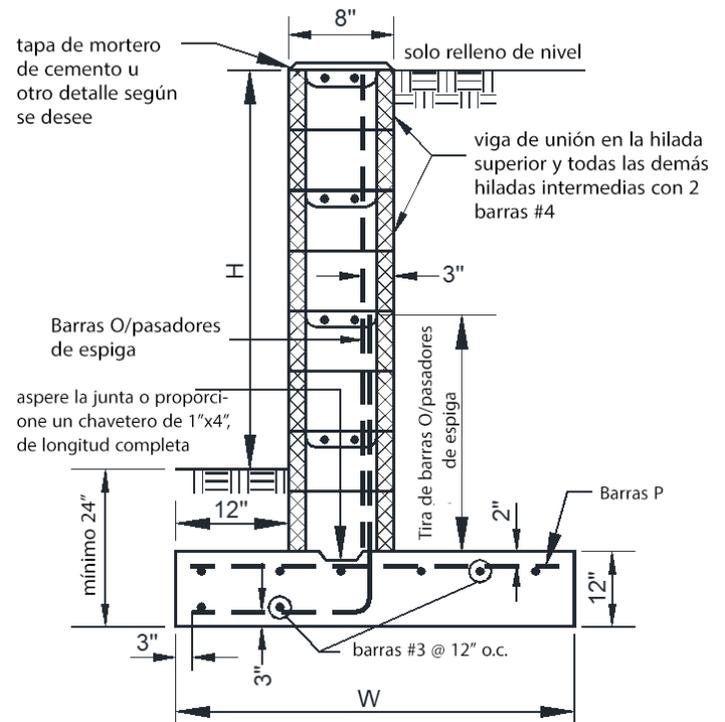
SECCIÓN TÍPICA DE MURO DE MAMPOSTERÍA
